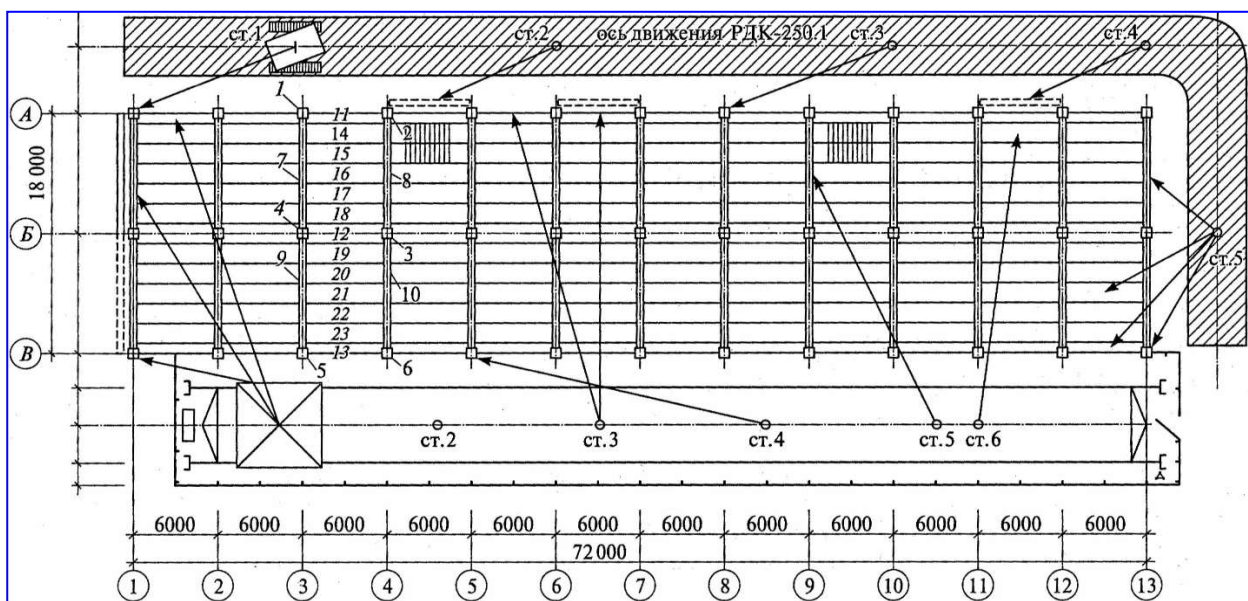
Фрагмент строительного генерального плана на период монтажа надземных конструкций многоэтажного каркасного здания:
